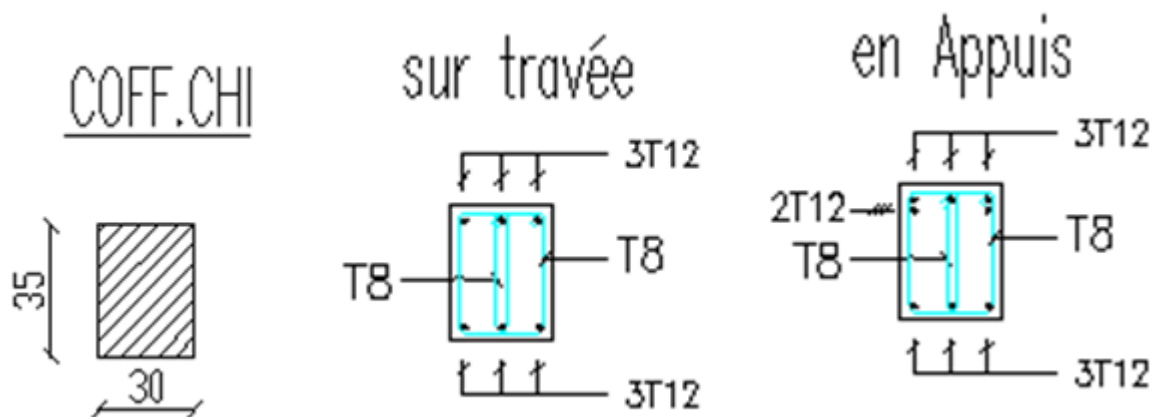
Schéma de ferrailage de la poutre secondaire.
